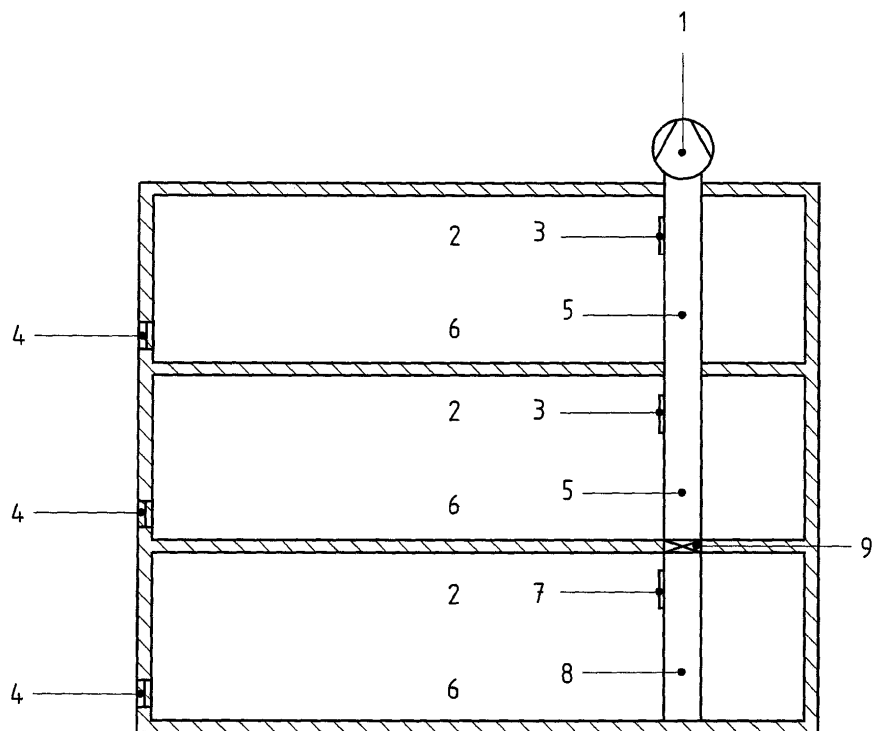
Механическая вентиляционная система тепло- и дымоудаления в здании со множеством помещений
